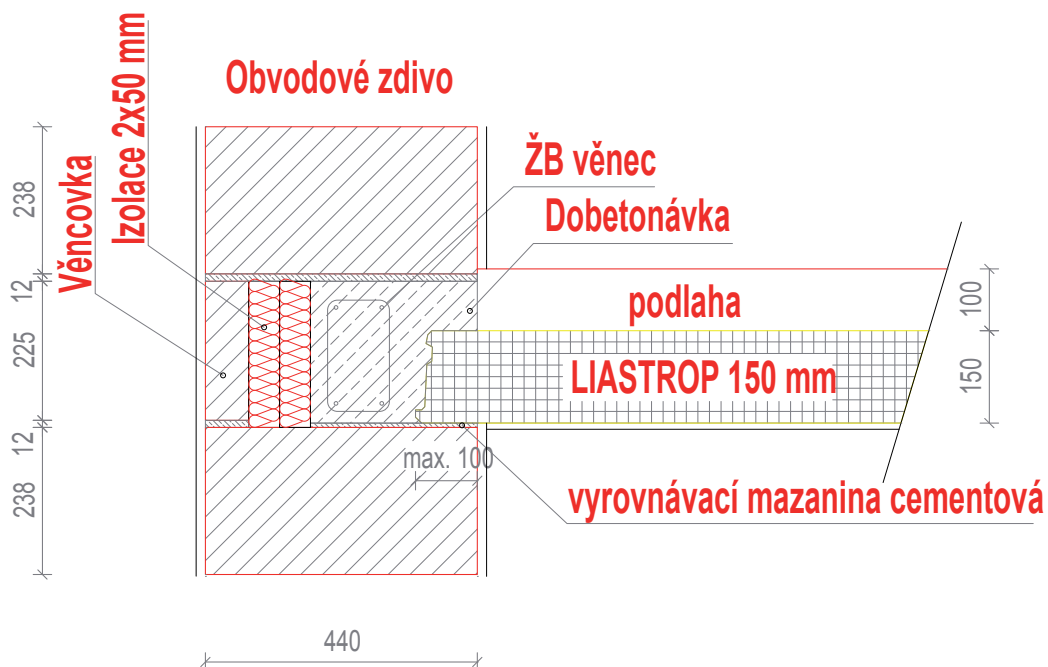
Uložení stropních dílců tl. 250 mm na obvodovou stěnu na železobetonový věnec s U profilem
